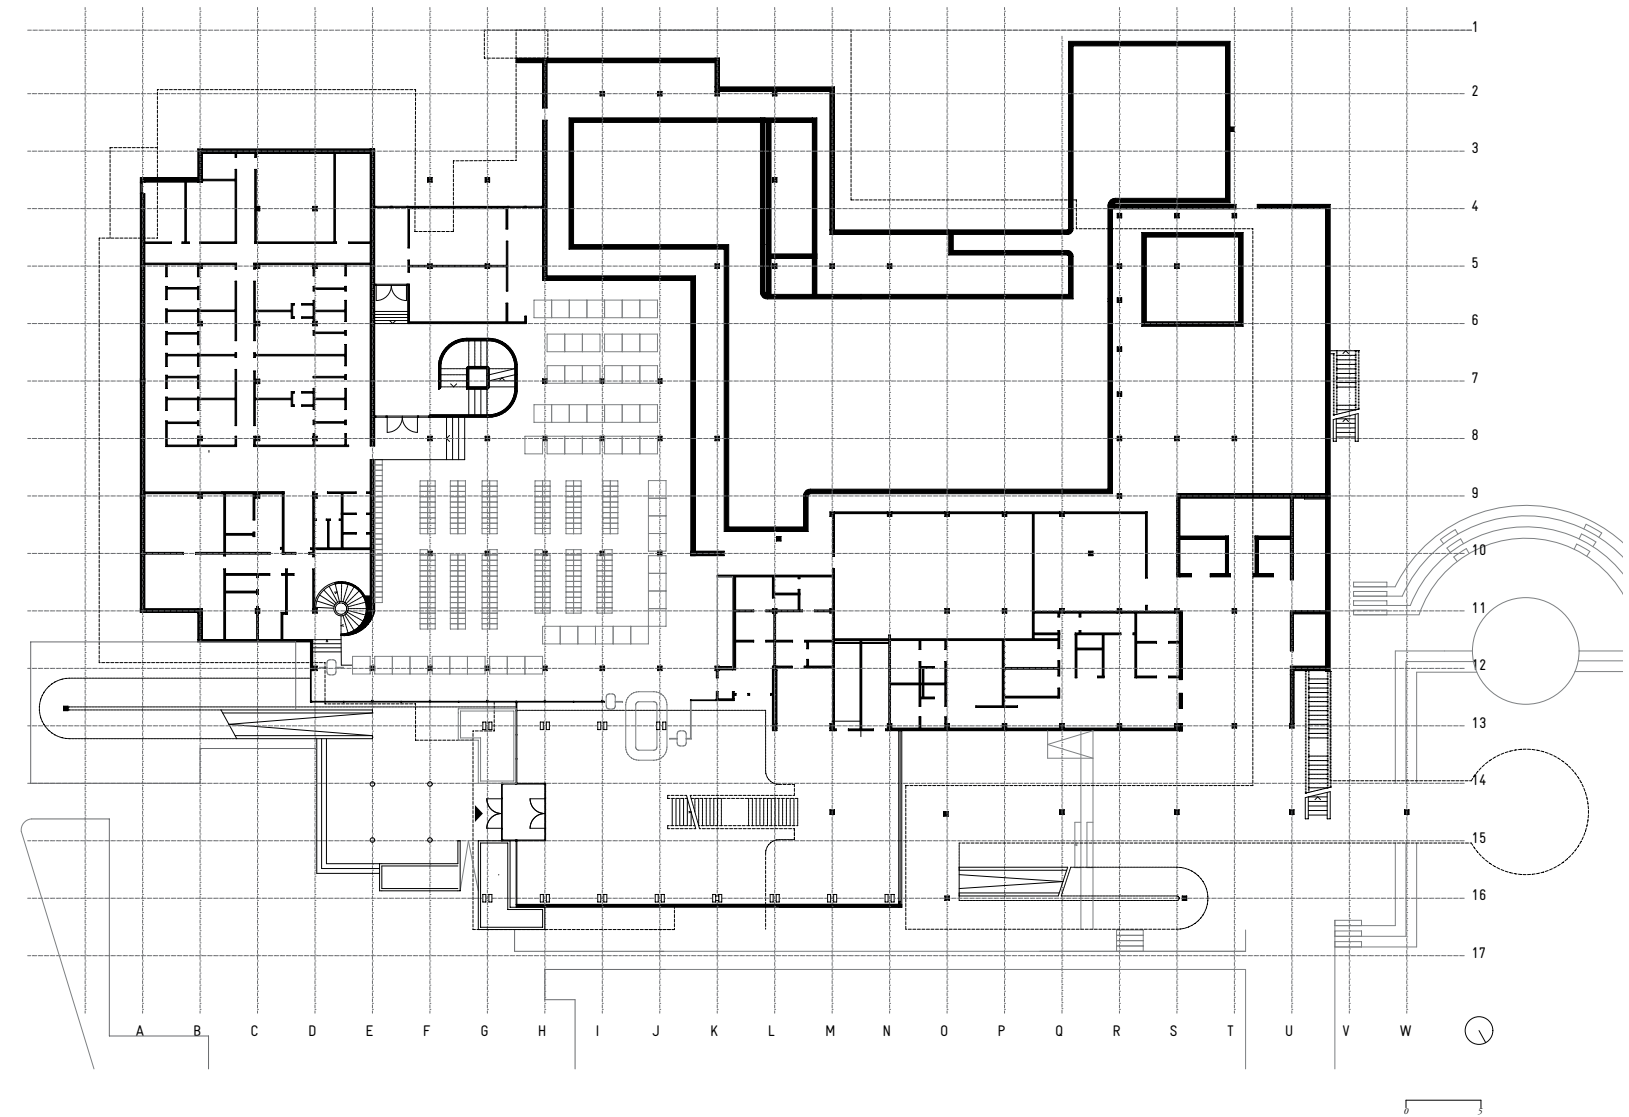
Grundriss Erdgeschoss 1:500, rekonstruiert
